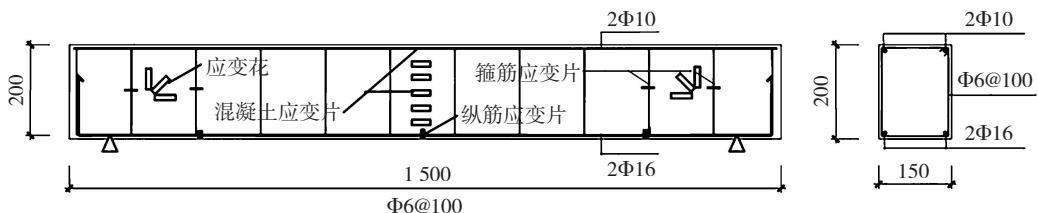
CARCB 的尺寸与截面配筋详图 (mm)
